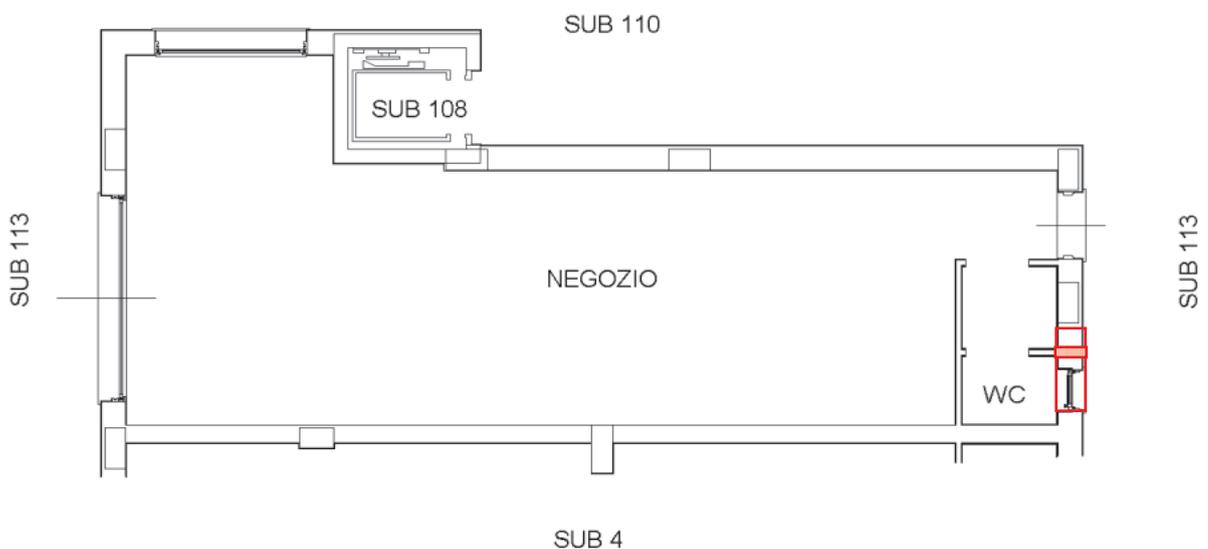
Lotto L5 : Planimetria del locale commerciale sub. 3
